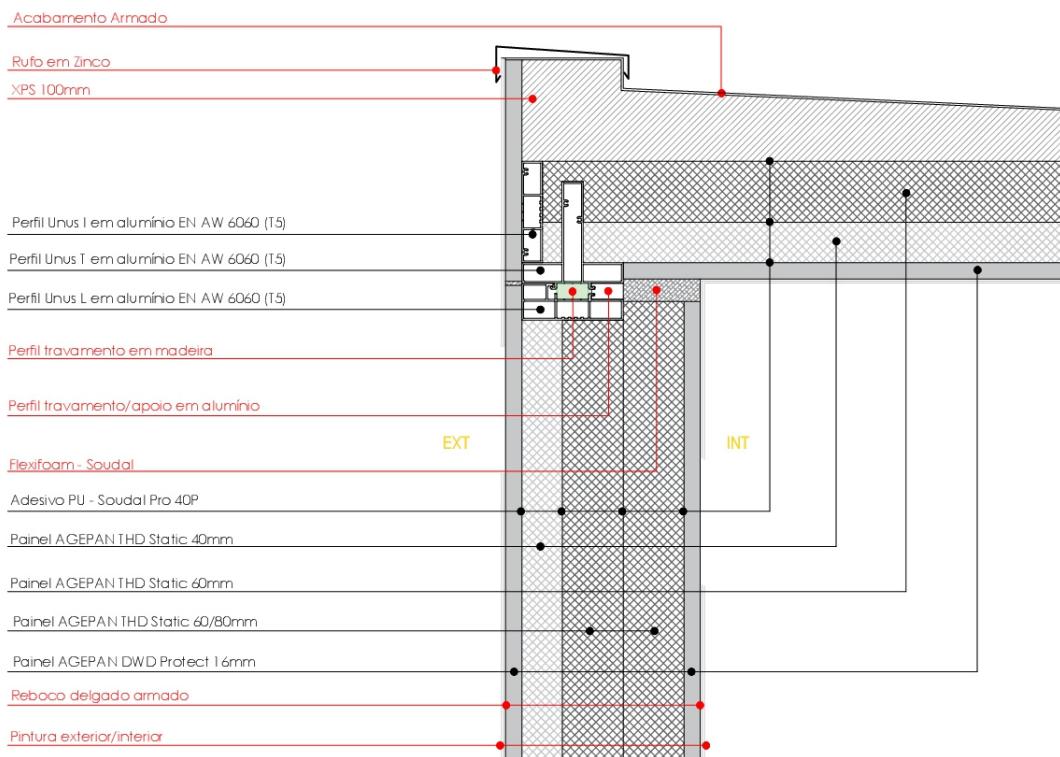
Solução AGEPLAN – Pormenor Construtivo de Paredes Verticais/Coberturas.
